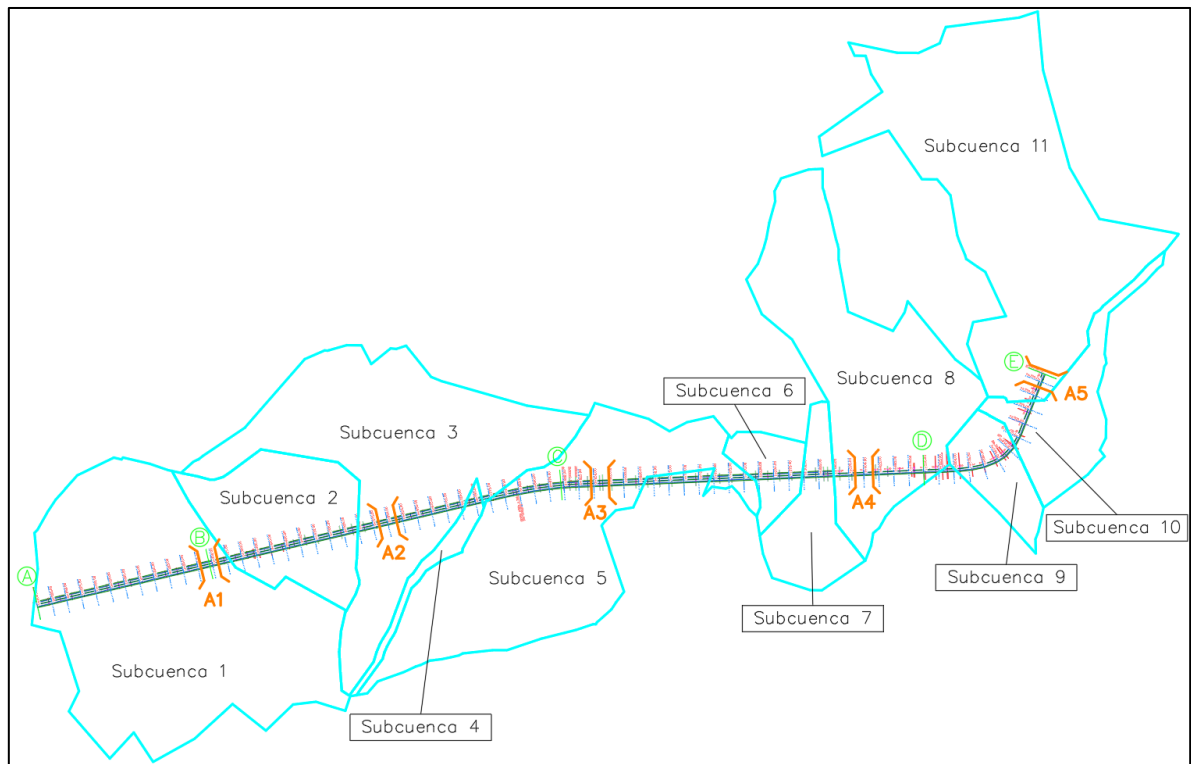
Trazado de Alcantarillas. Fuente: Elaboración propia.
